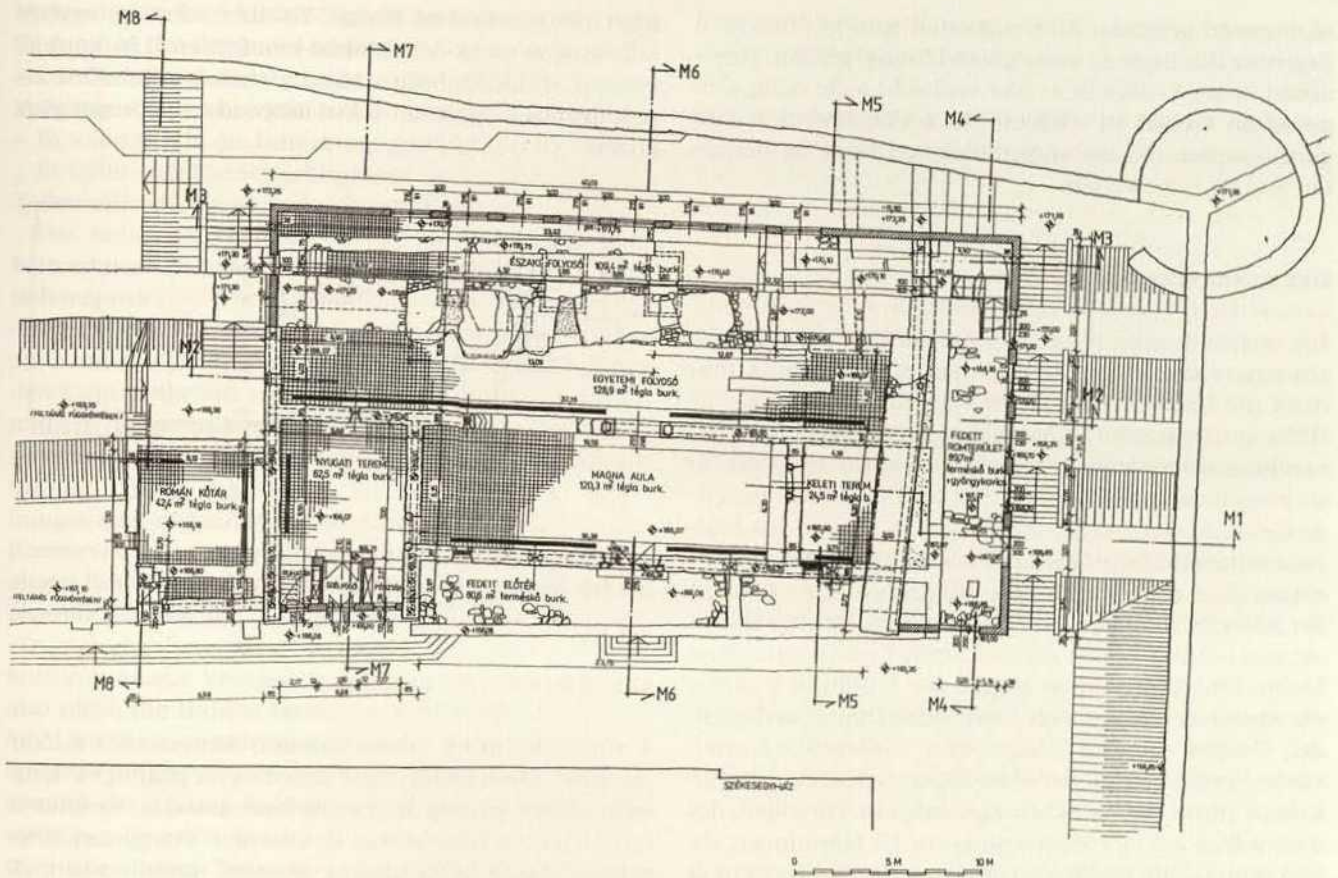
Grundriß der Universität 125. kép. Az egyetem alaprajza
